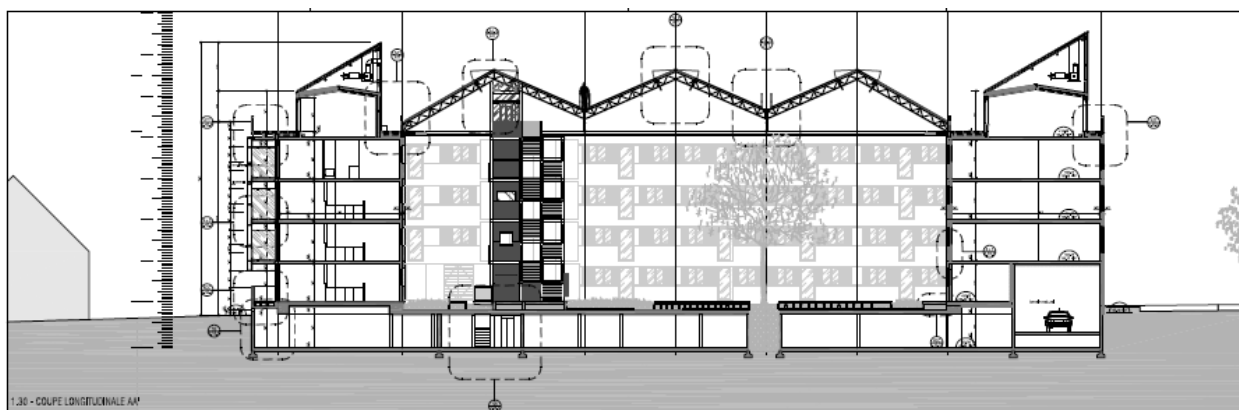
Coupe longitudinale de la serre (Source : plans architecte)
